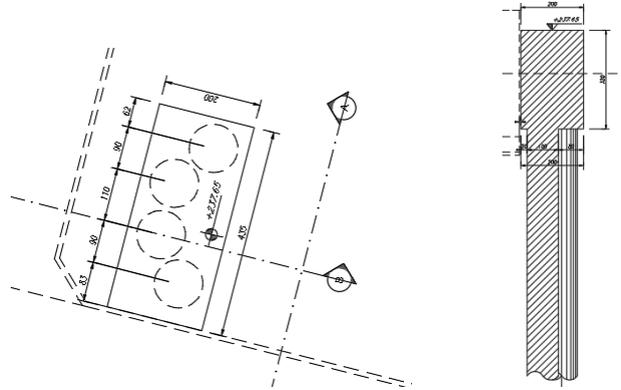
Pianta e sezione dell'opera di protezione dall'urto del treno
